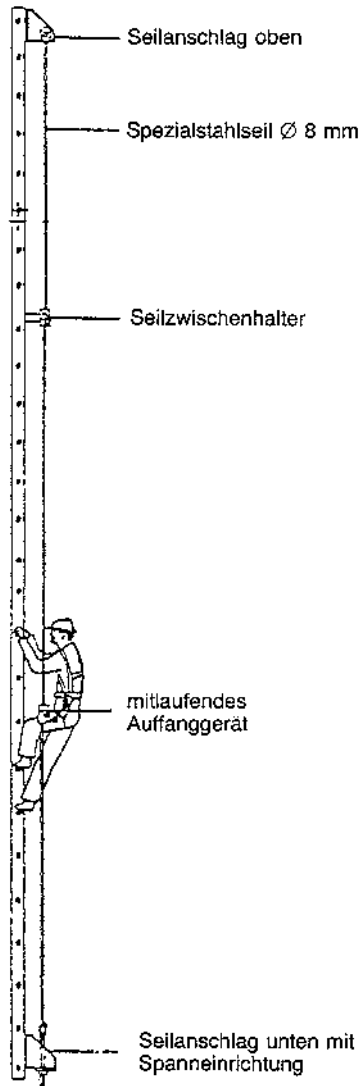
Beispiel einer Steigschutzeinrichtung mit Führung aus Stahldrahtseil
